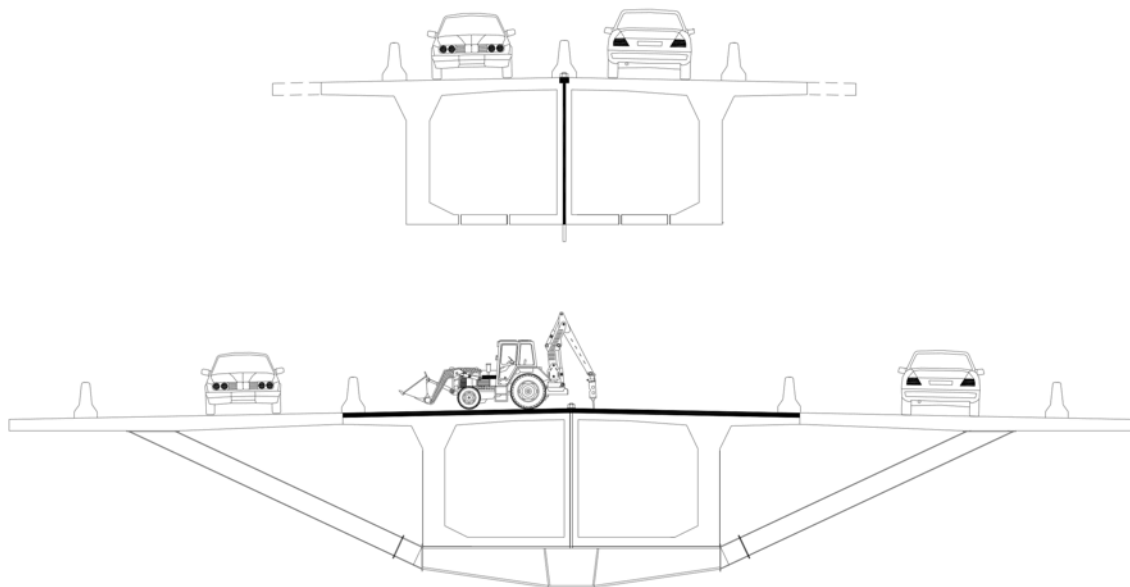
Construcción de la tercera alma de hormigón para la adición de la estructura metálica que da soporte a los jабalcónes metálicos que sustentan la nueva losa de hormigón ampliado.
